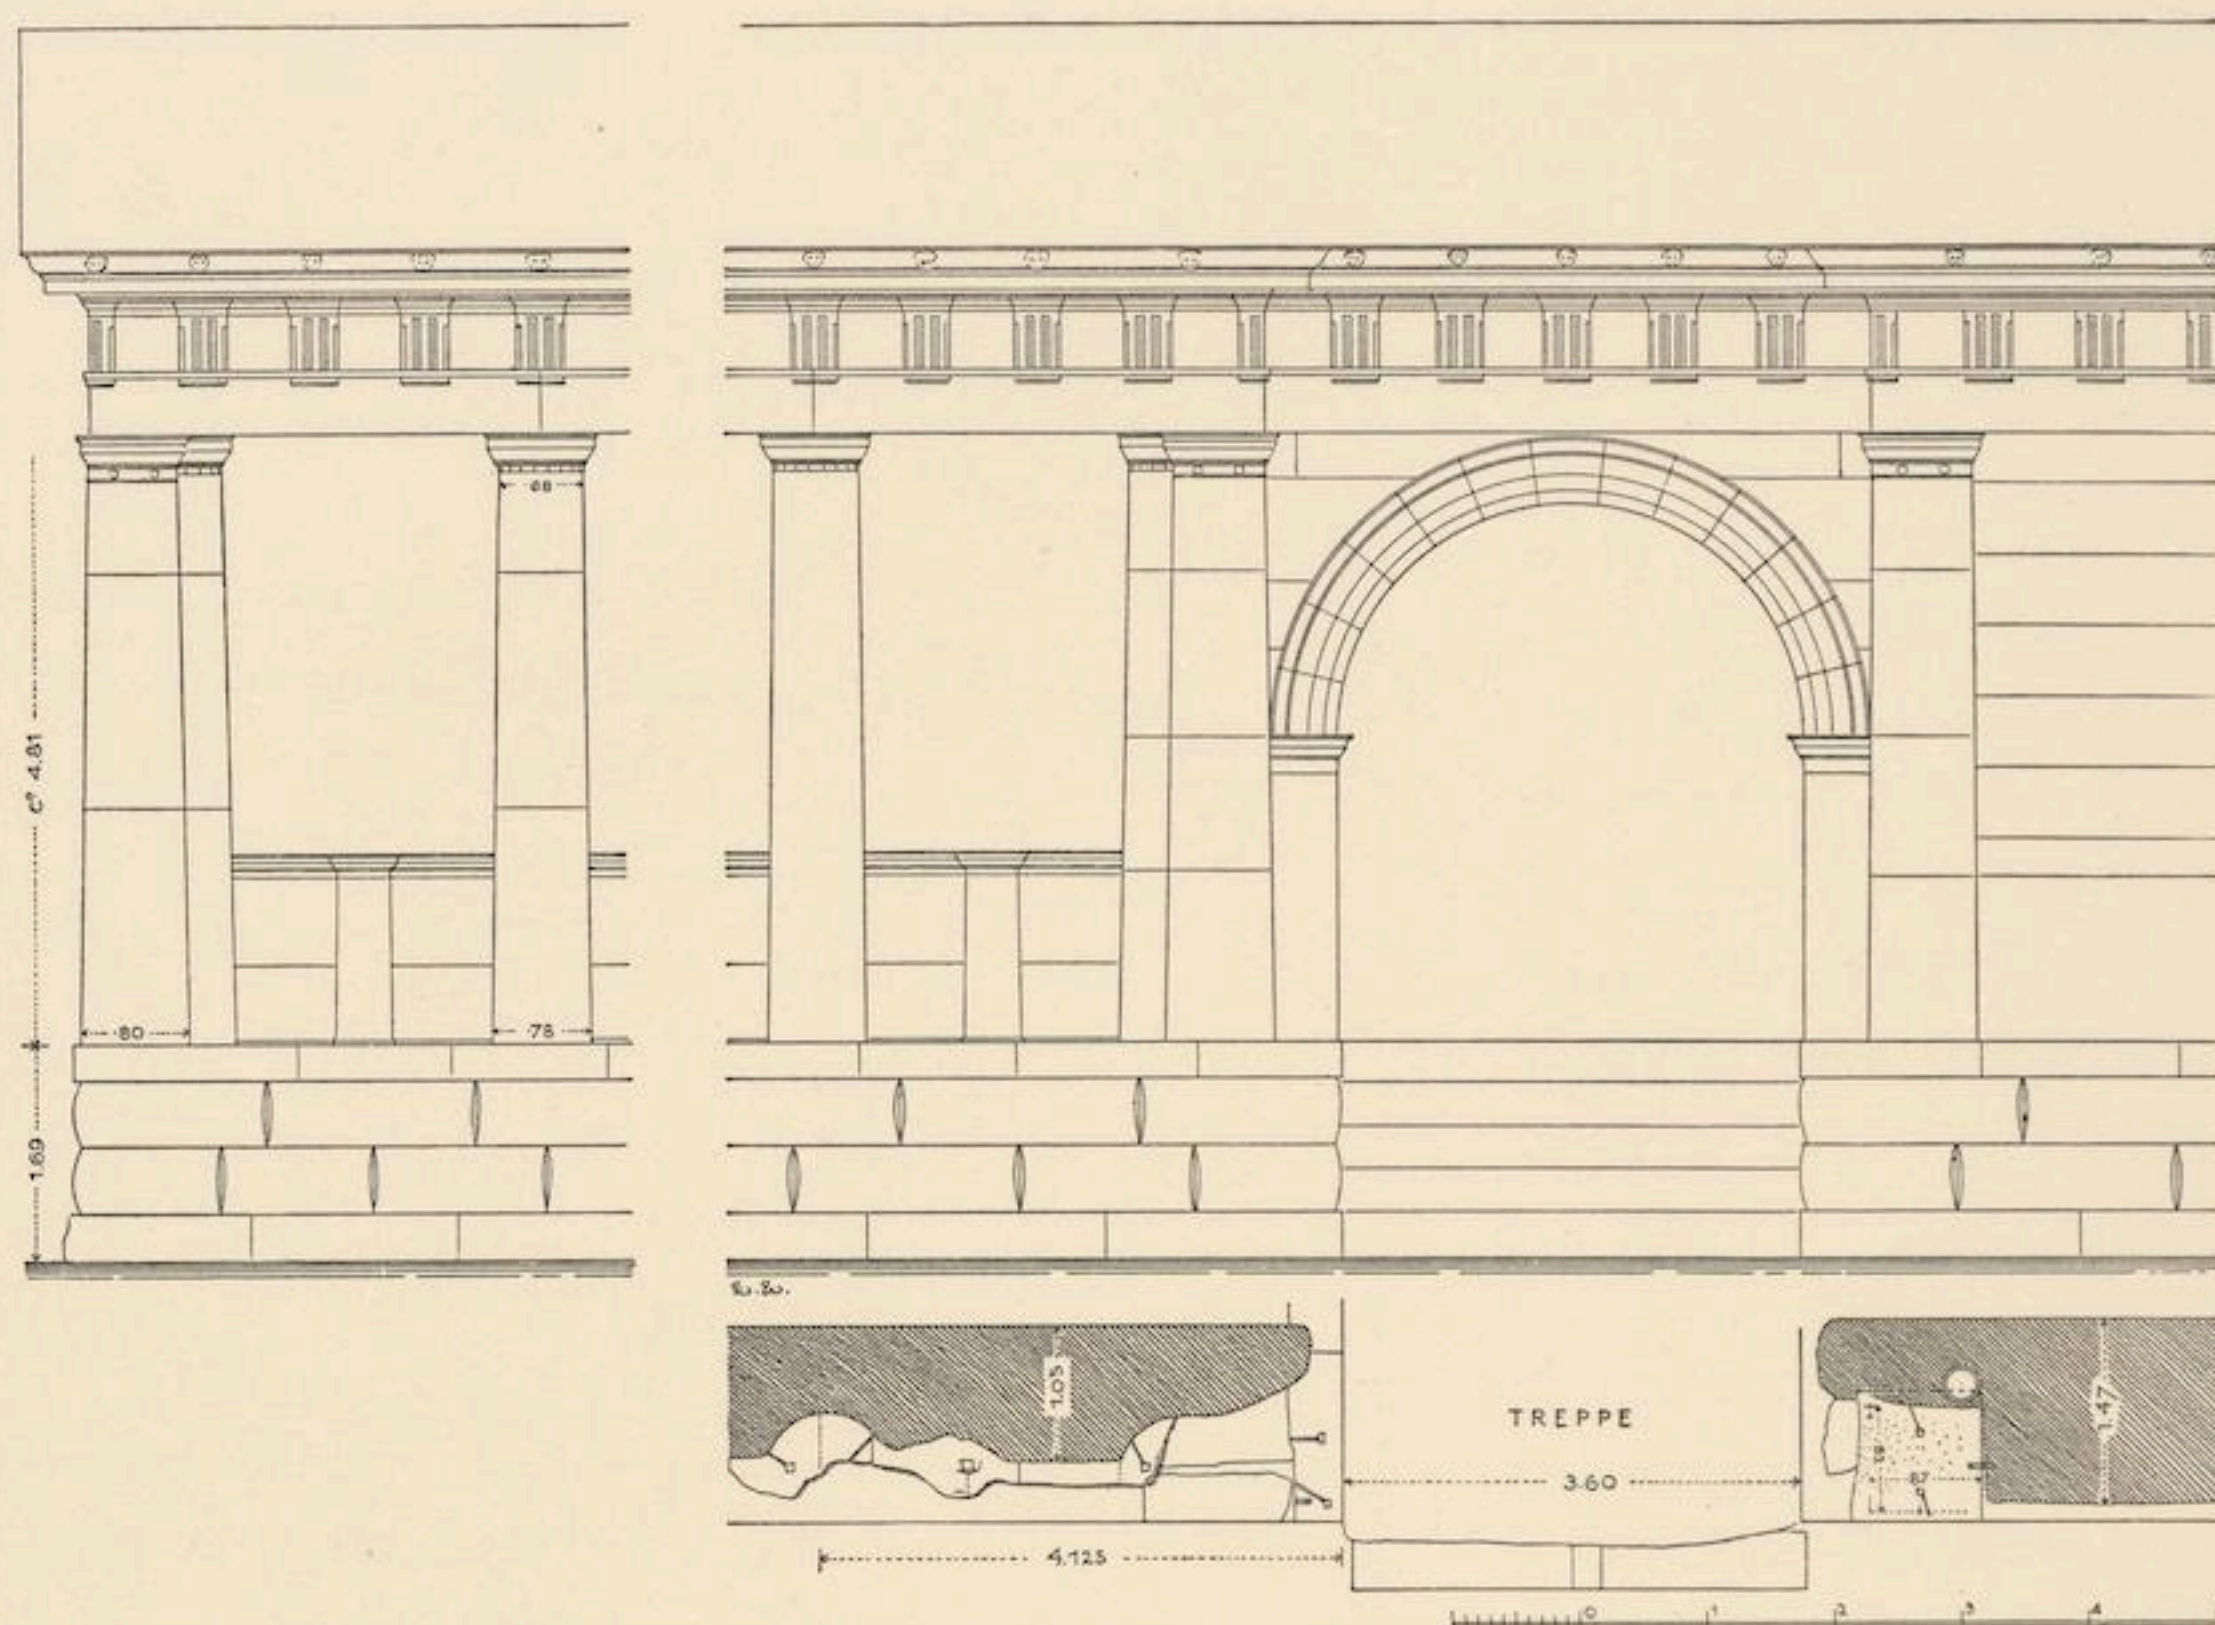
Südecke der Säulenhalle und Eingangstor.
